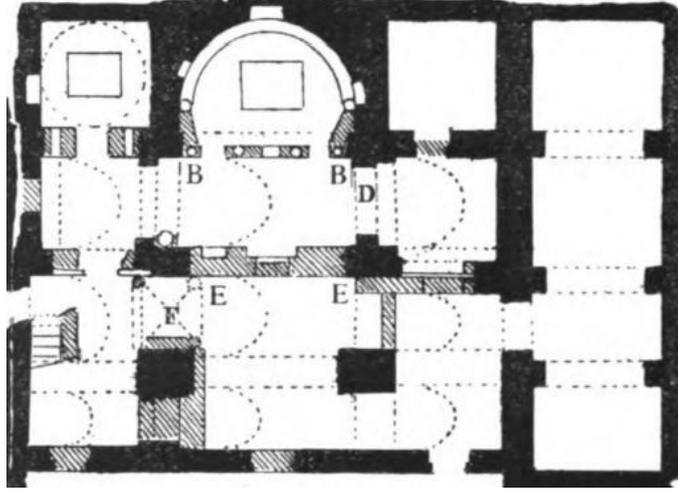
مسقط أفقي لكنيسة الست دميانة والأنبا موسىس بالعراية
